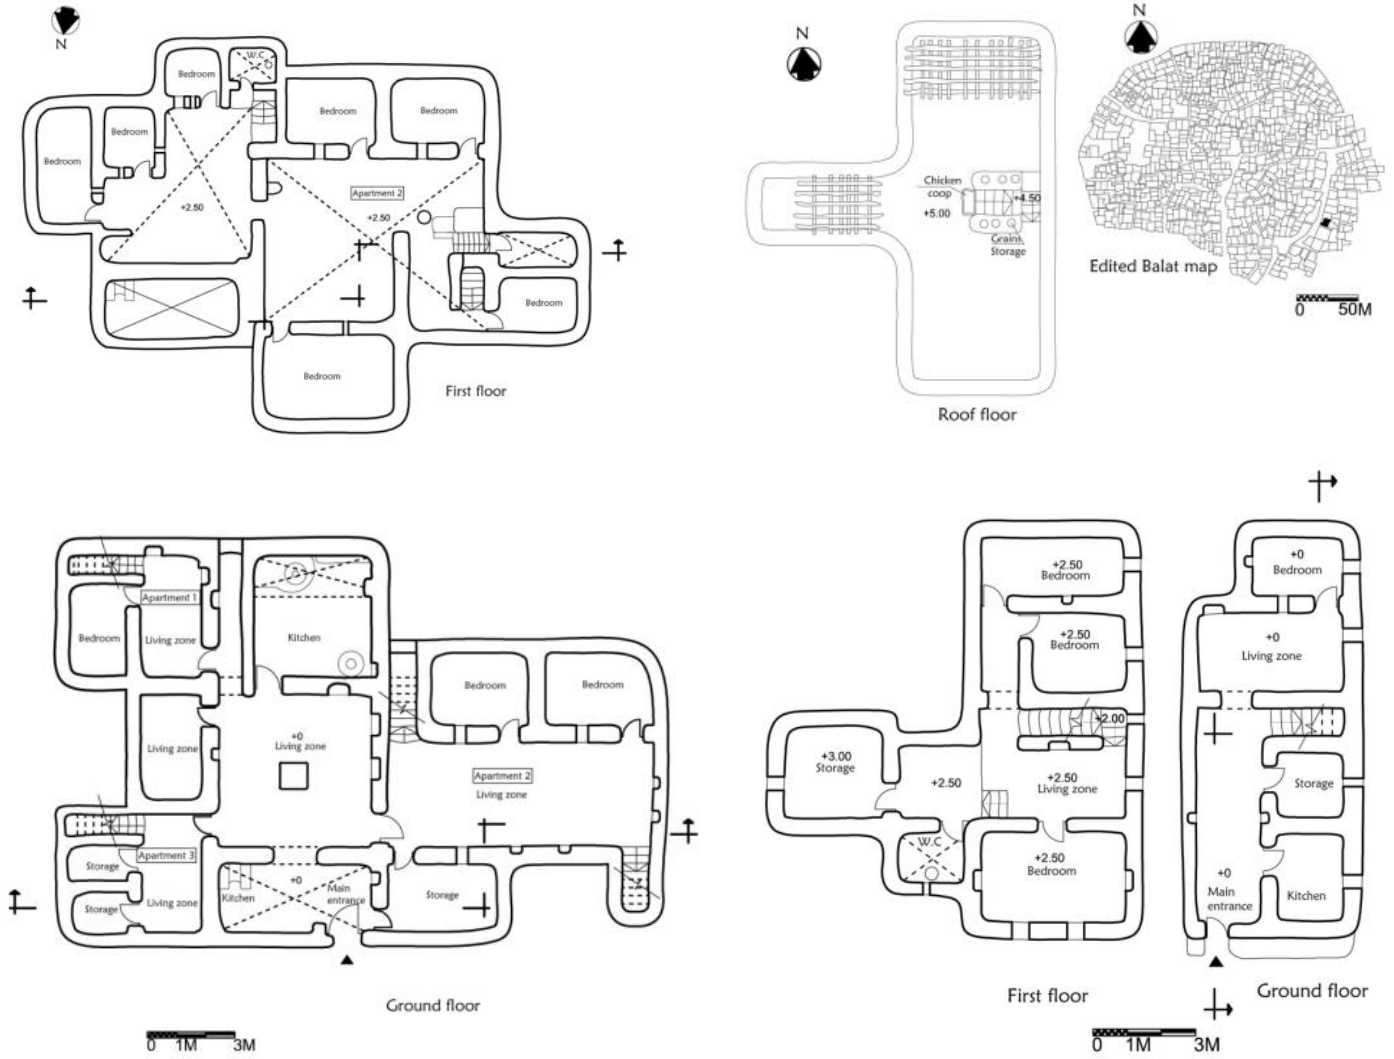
مسقط أفقي لمنزل عائلي صغير يتسع لـ ٦ أشخاص
